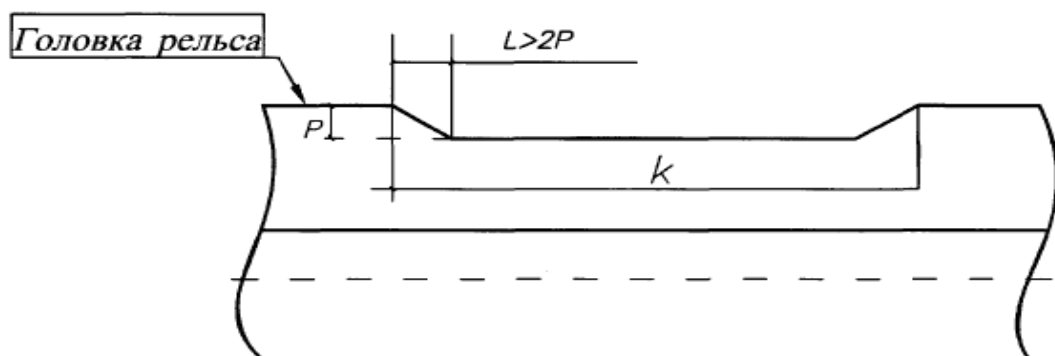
Схема вышлифовки дефекта перед наплавкой сварного стыка
